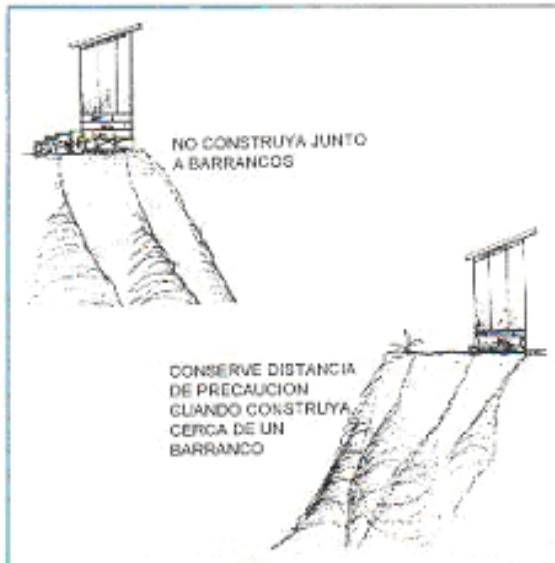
Construcción de LASF en lugares cercanos a barrancas
